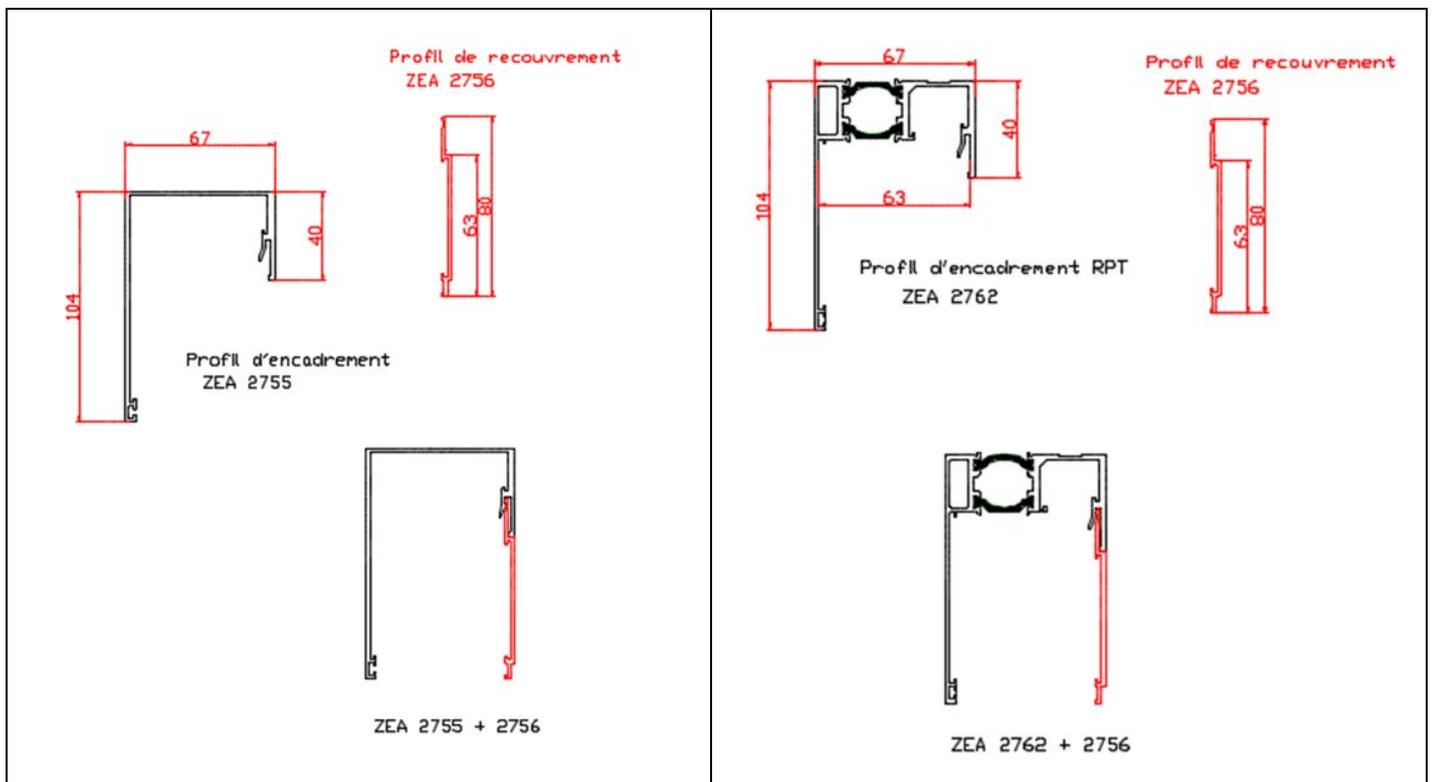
Profil haut et latéral pour plaques Akyver Connect® 25
